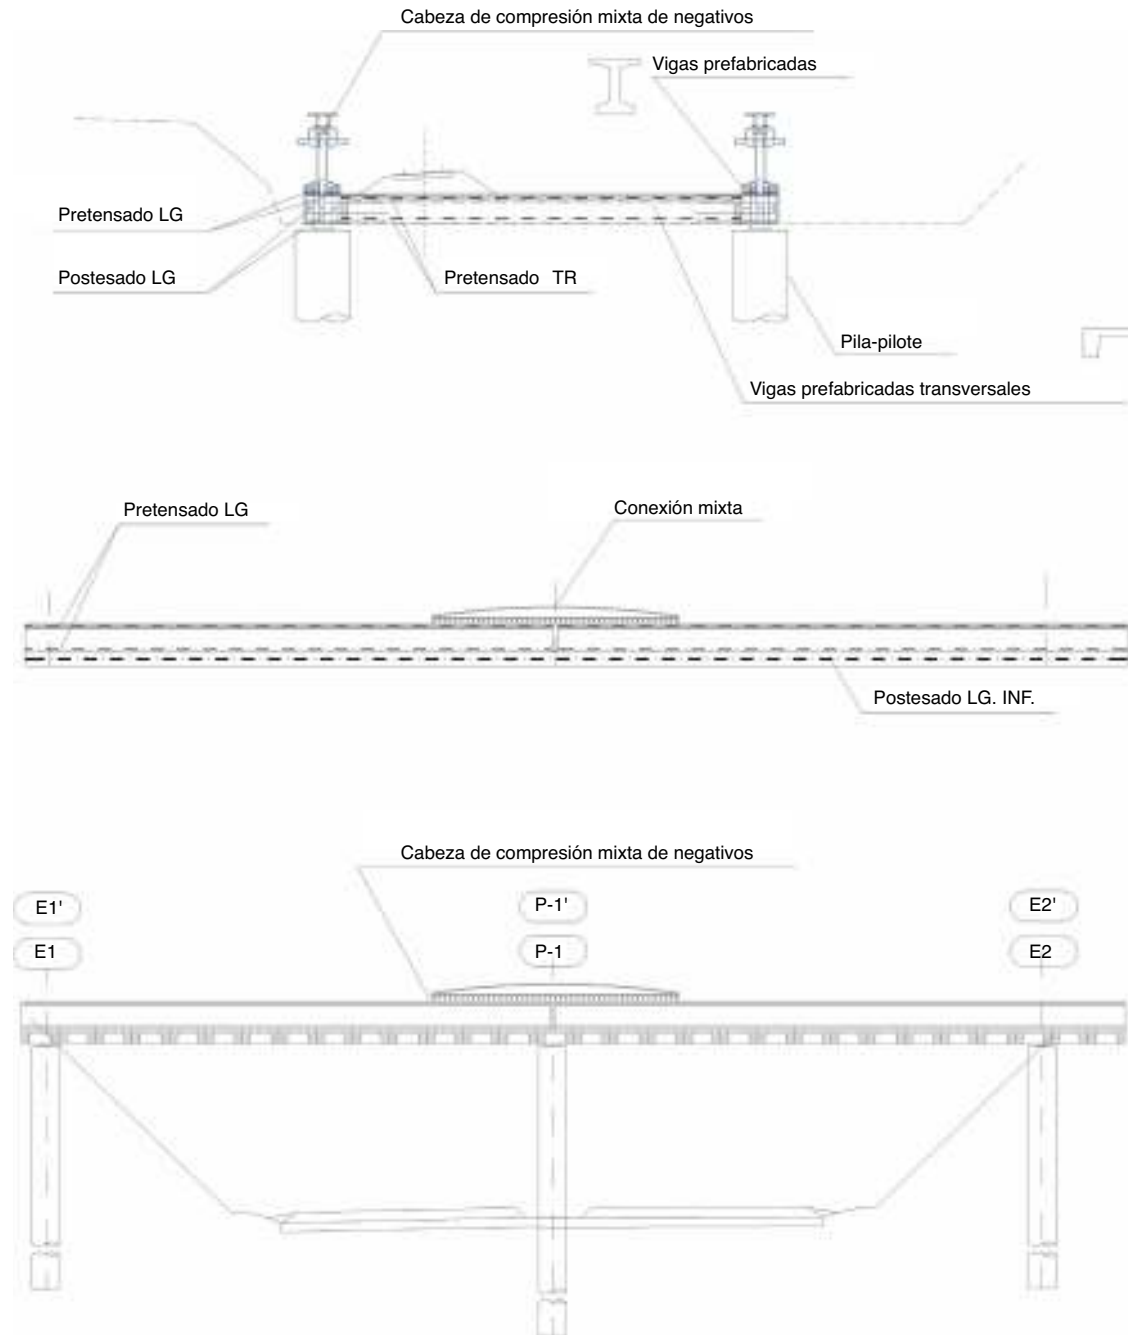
Variante solución 2 con viga longitudinal prefabricada. Esquema conceptual.
